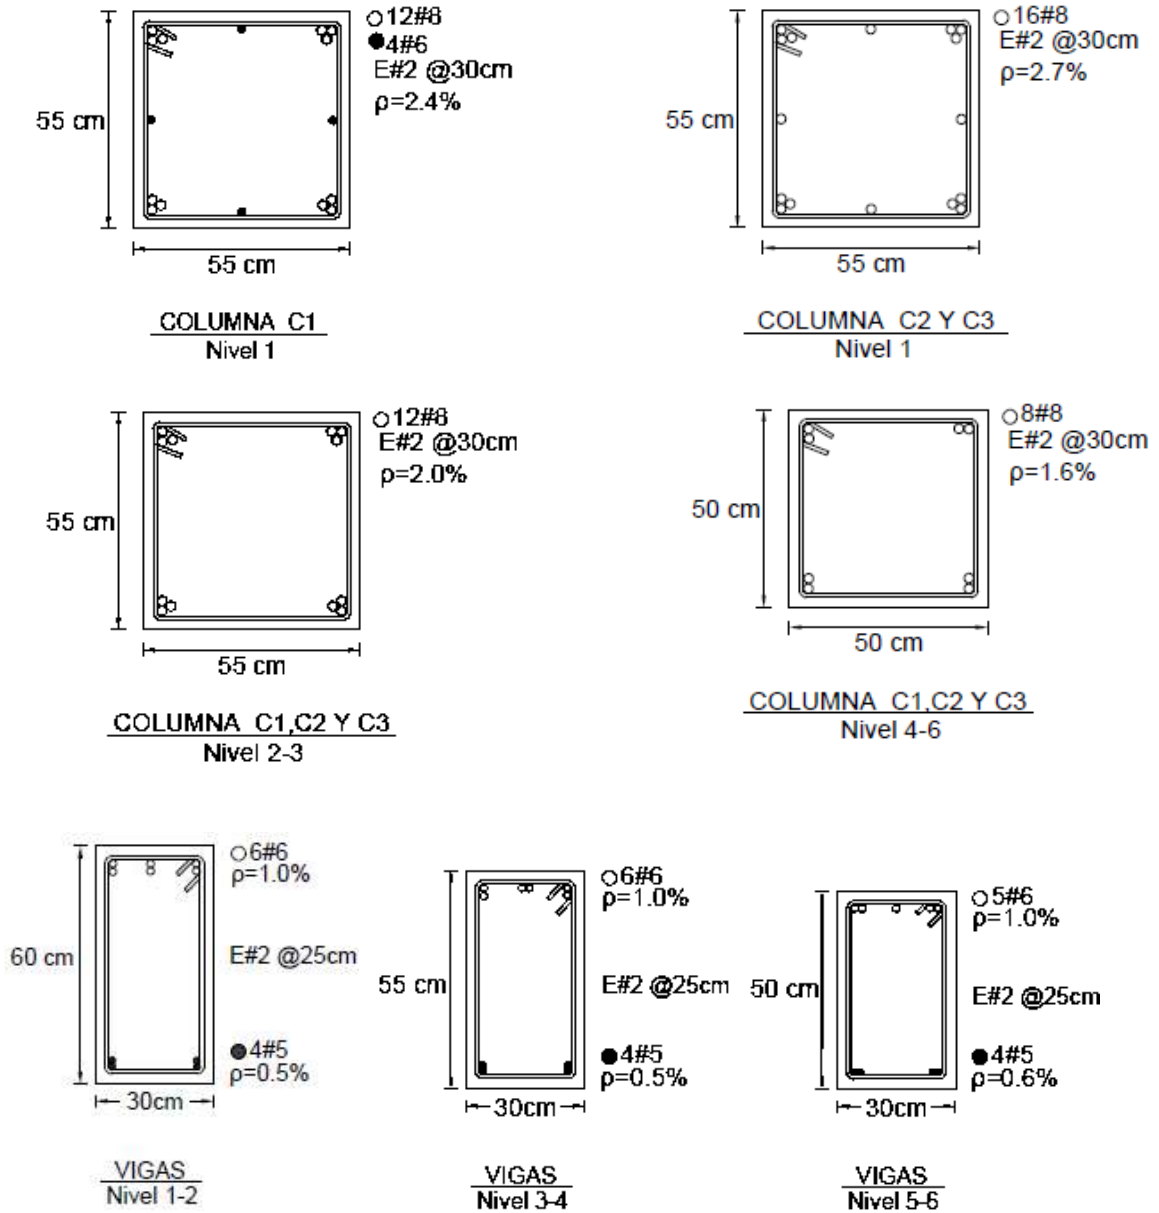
Armado de vigas y columnas del edificio de 6 niveles diseñado con las NTCS-76 con un Q igual a 4
